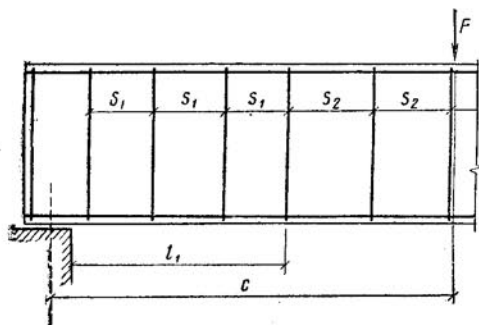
К расчету балки с разным шагом поперечных стержней
